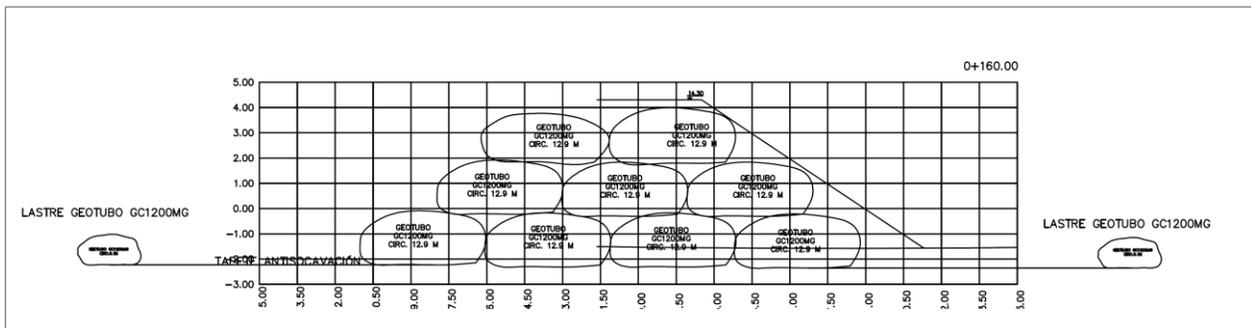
Sección típica de la estructura de la escollera que incluye el tapete anti-socavación y los tubos geotextiles apilados para conformar la escollera hasta la altura de diseño (cota +4.30 m).
